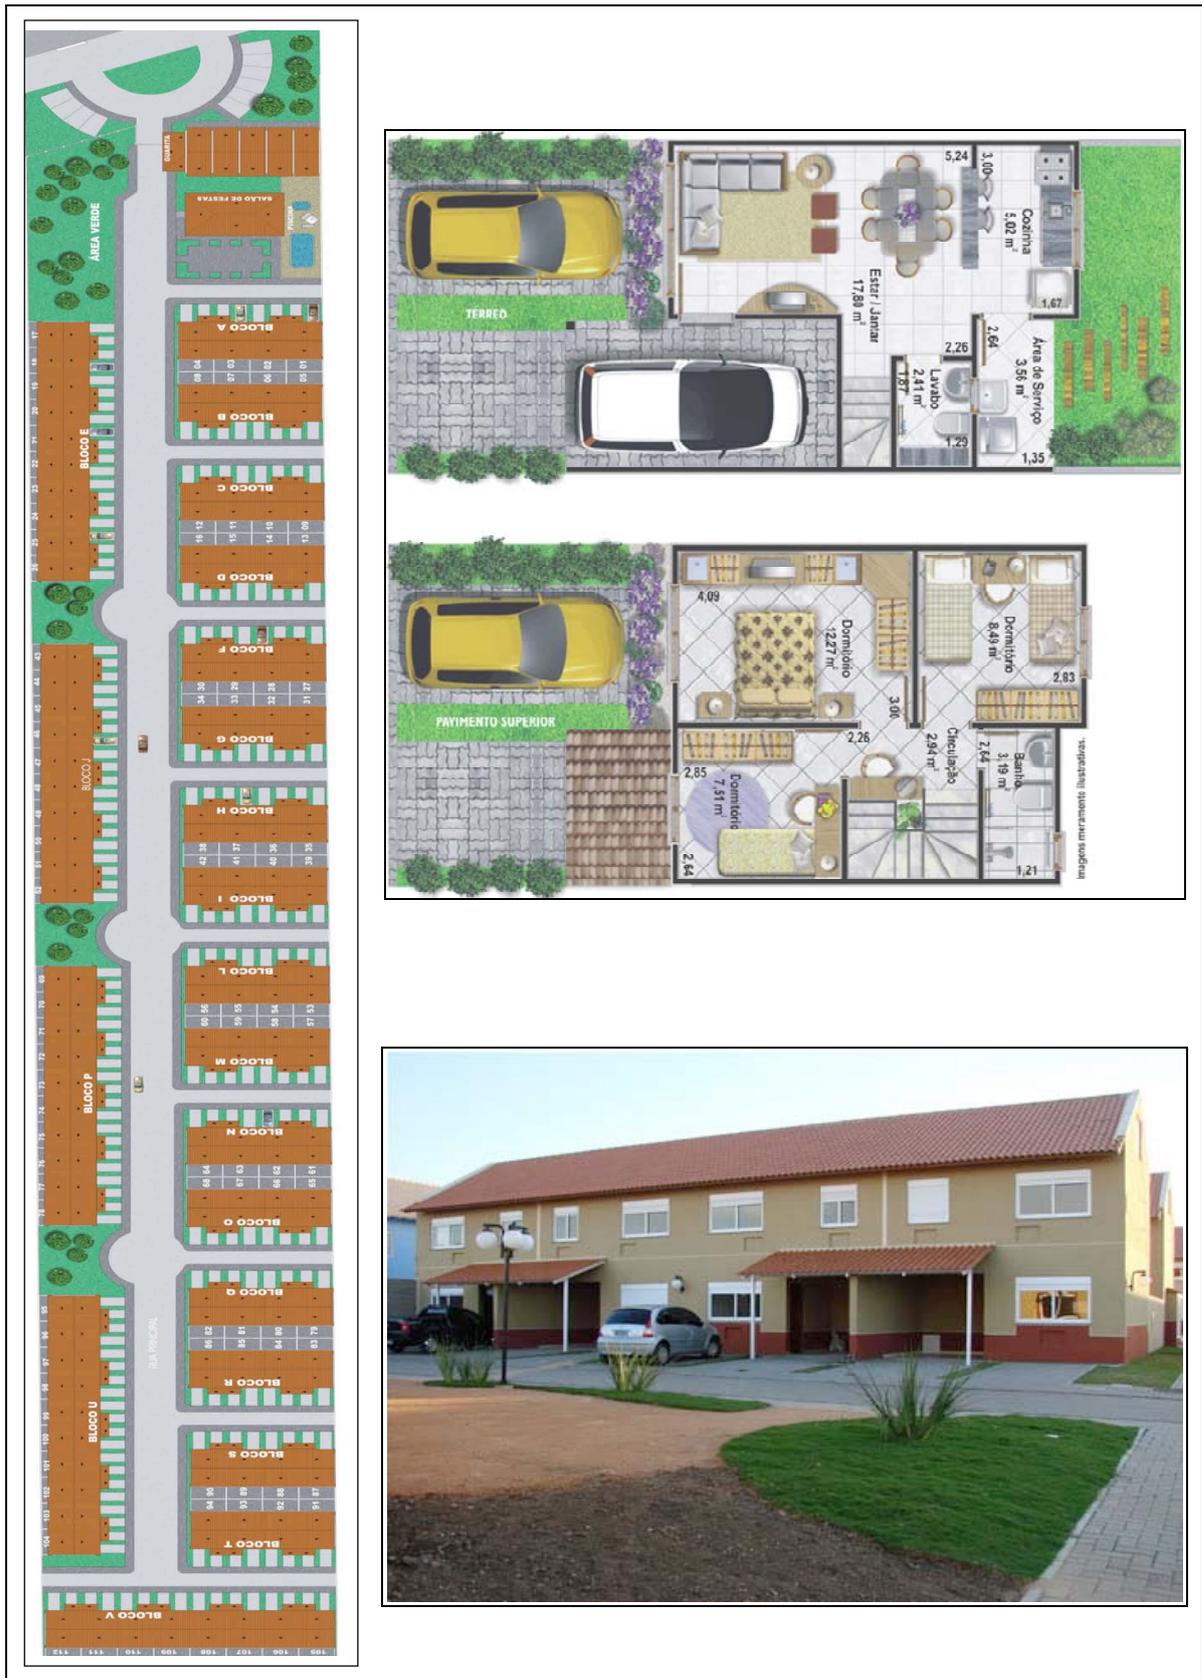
implantação, plantas baixas da unidade habitacional e foto de um bloco do empreendimento X1
